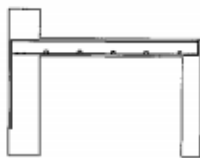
Detalhe da armadura da laje LA que ligam as vigas VA e VB
